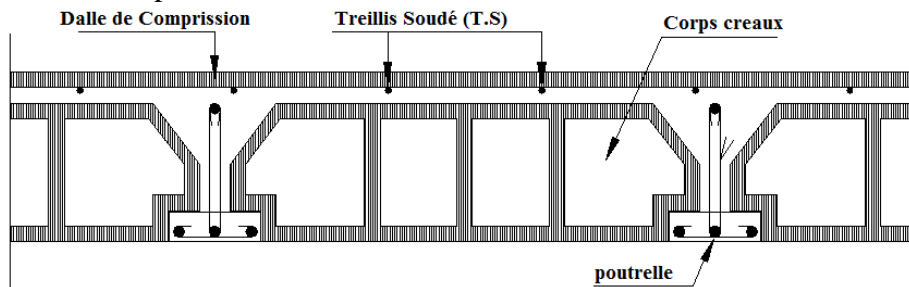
Coupe transversale d'un plancher à corps creux
